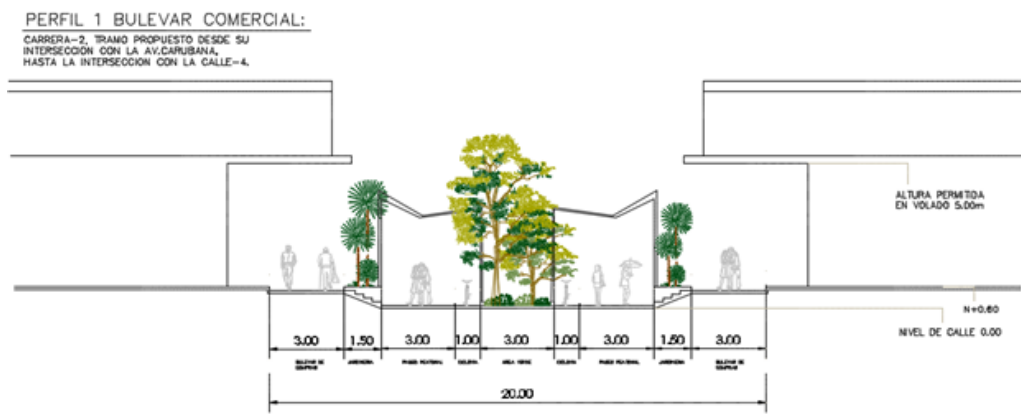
Perfil vial propuesto. Boulevard peatonal. Fuente: Flores y otros. (2018)
